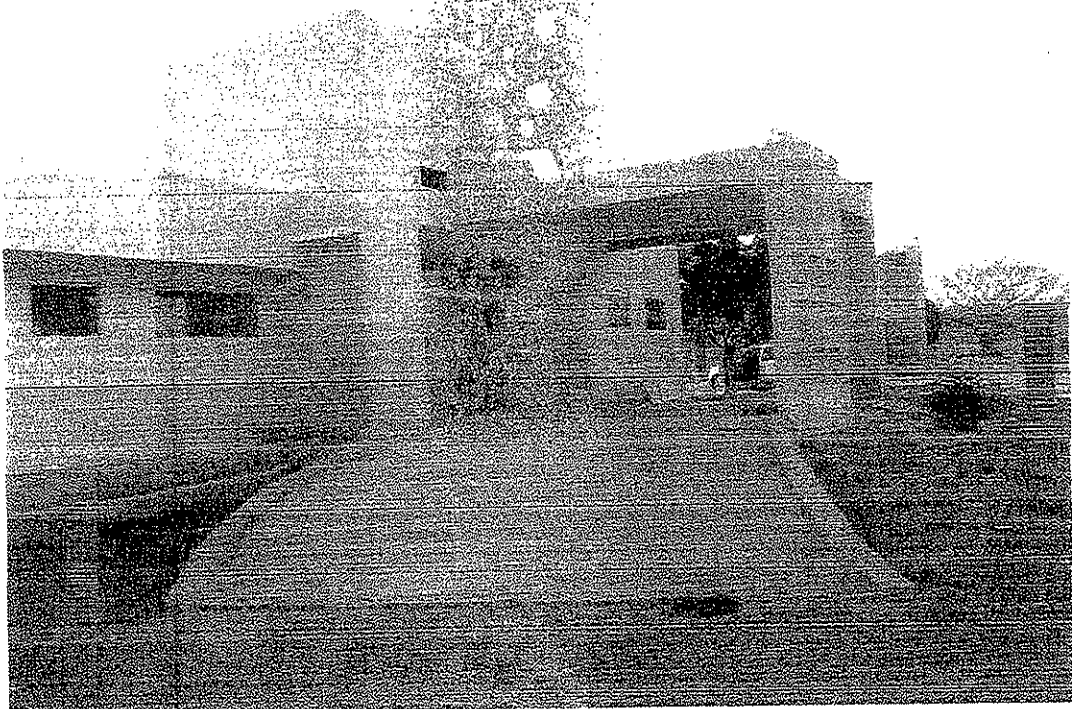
Detalhe da ausência da pavimentação em blocos de concreto sextavado, pintura acrílica para estacionamentos e paisagismo em todo o contorno da edificação.
